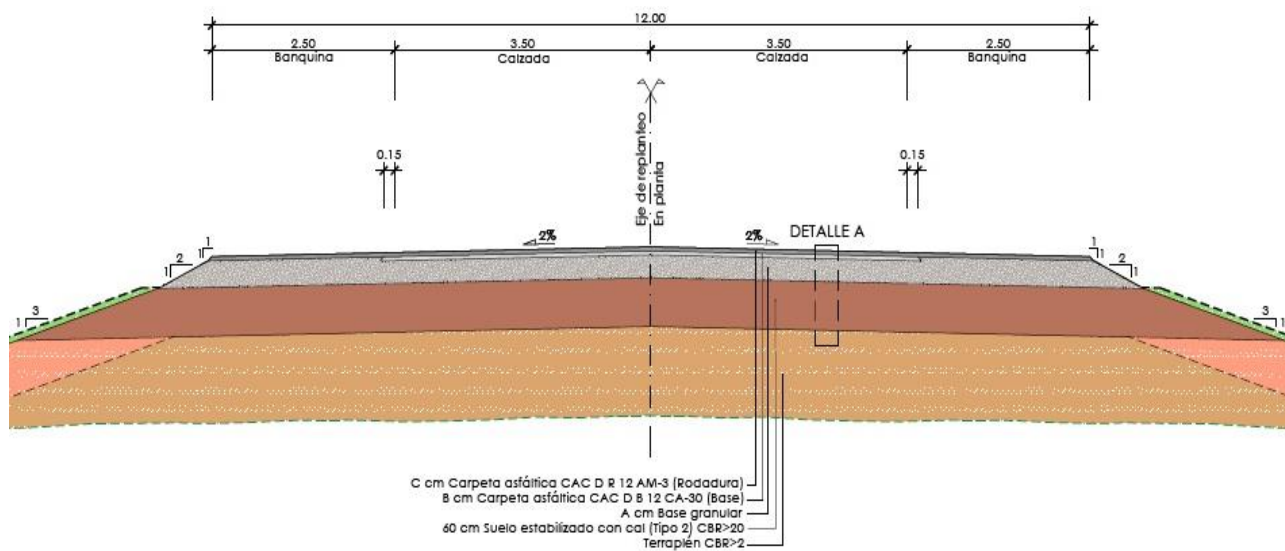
Sección tipo de obra básica y estructura de pavimento, calzada principal
